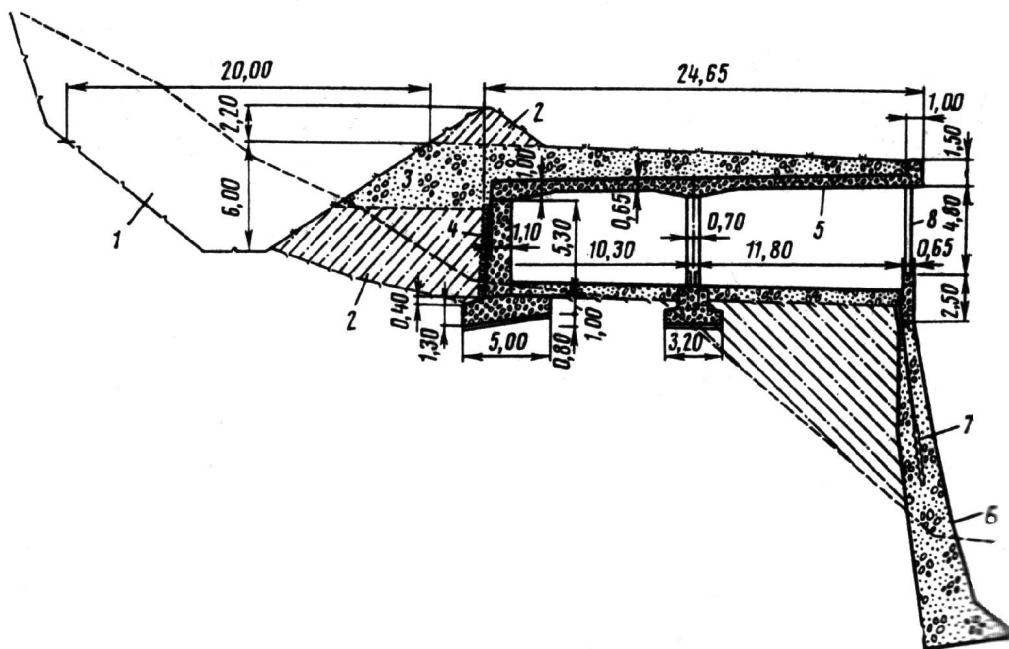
Конструкція камenezахисної галереї: 1 - вловлюючий ров; 2 - ґрунт; 3 - гравійна суміш; 4 - дренажний шар; 5 - галерея із збірних залізобетонних елементів; 6 - низова підпірна стінка; 7 - анкер, що закріплює поздовжню бетонну балку; 8 - металева стійка
